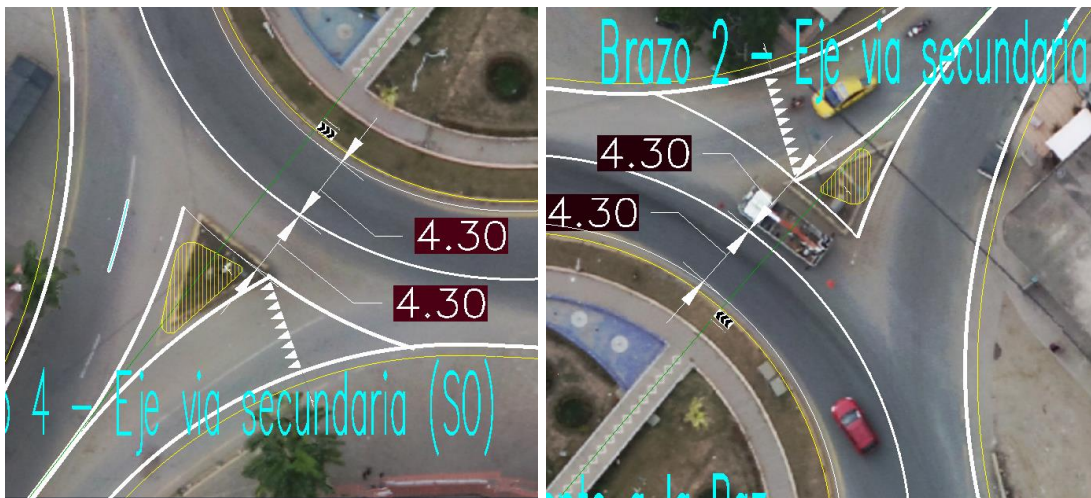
Ancho de circulación dentro de la rotonda, desplazamiento de isletas requerido. Fuente: Elaboración propia
